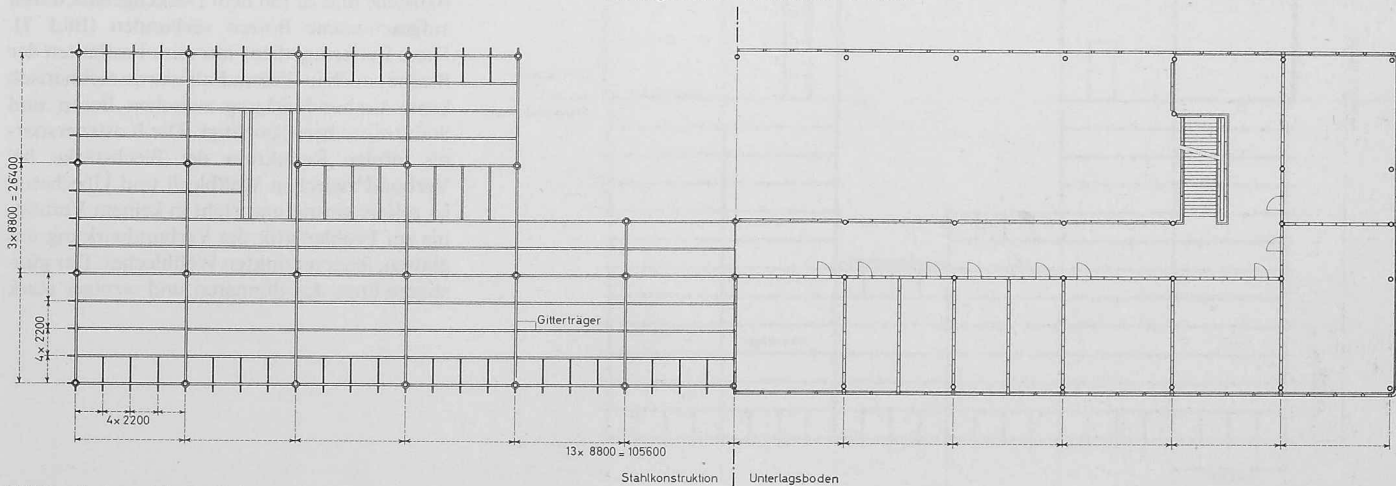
Laborgebäude, Schema-Grundriss 1:600
